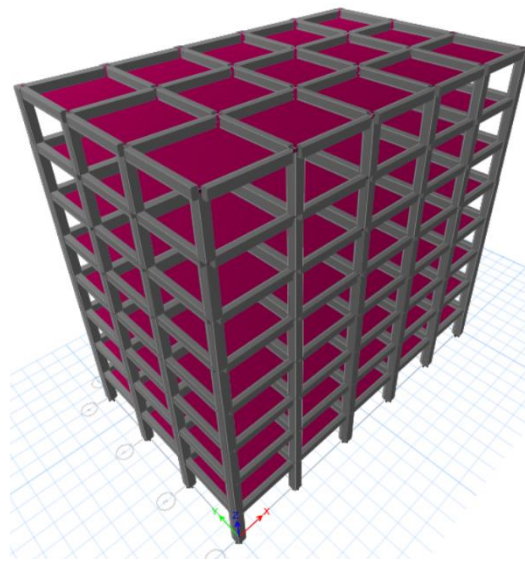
Modelo de estructura de hormigón armado. ETABS 18
